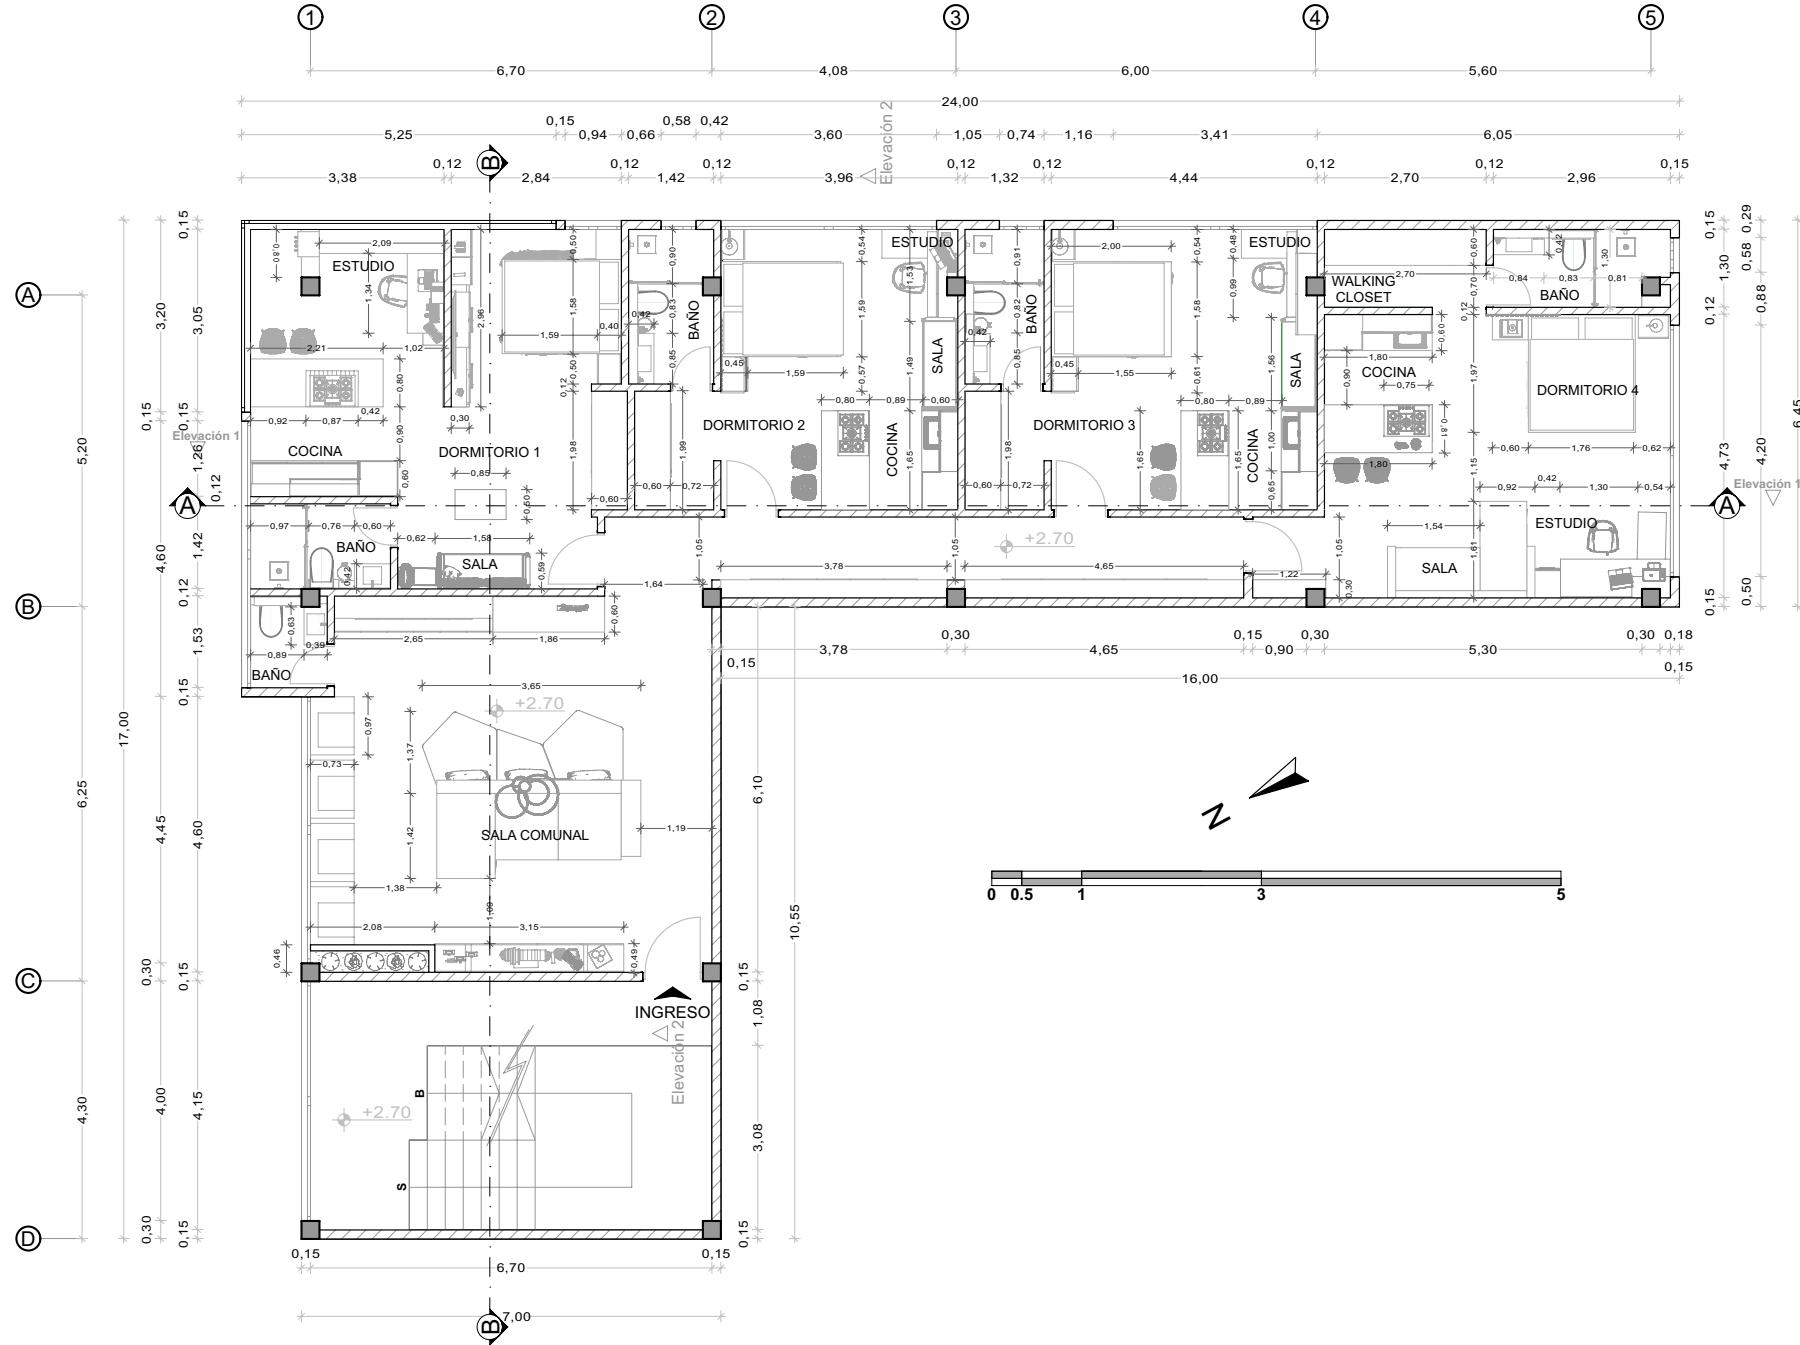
Autoría Jose Cruz. Planta Amoblada
